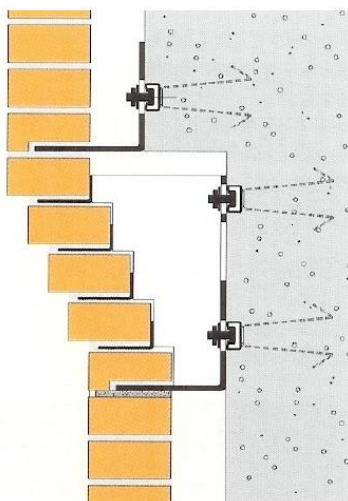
Fixação de tijolo com face à vista em parede de betão com saliência [48]
